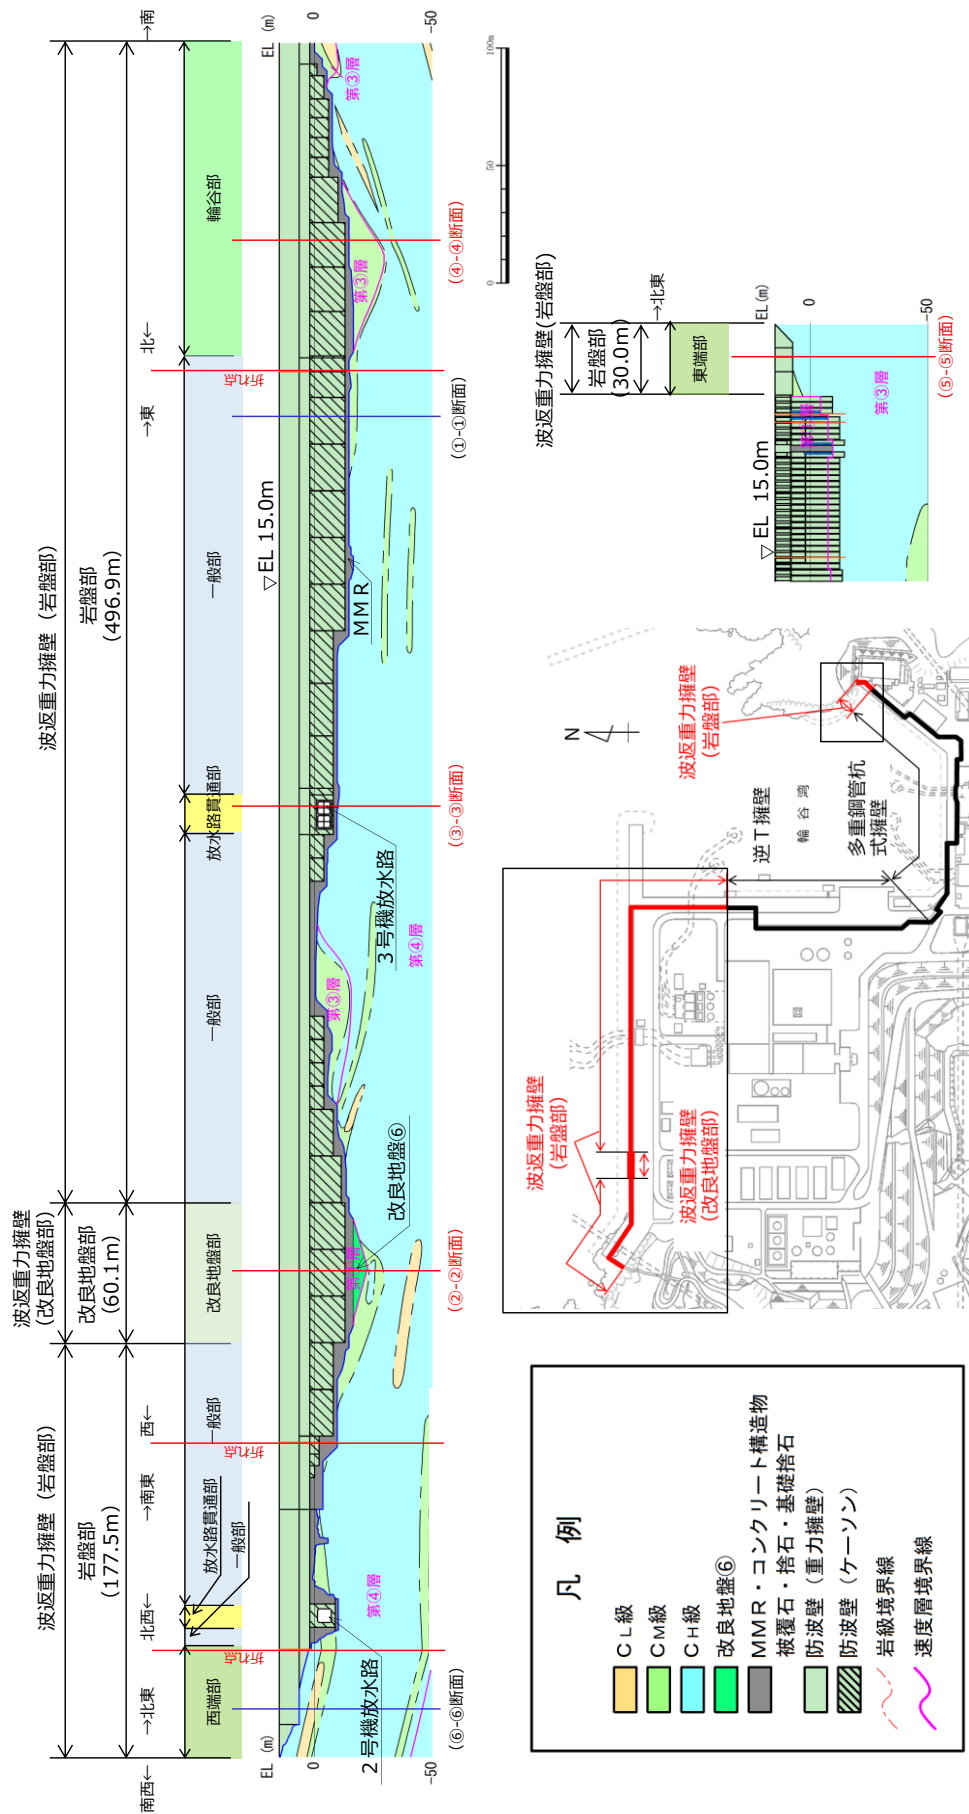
防波壁（波返重力擁壁）の縦断面図
